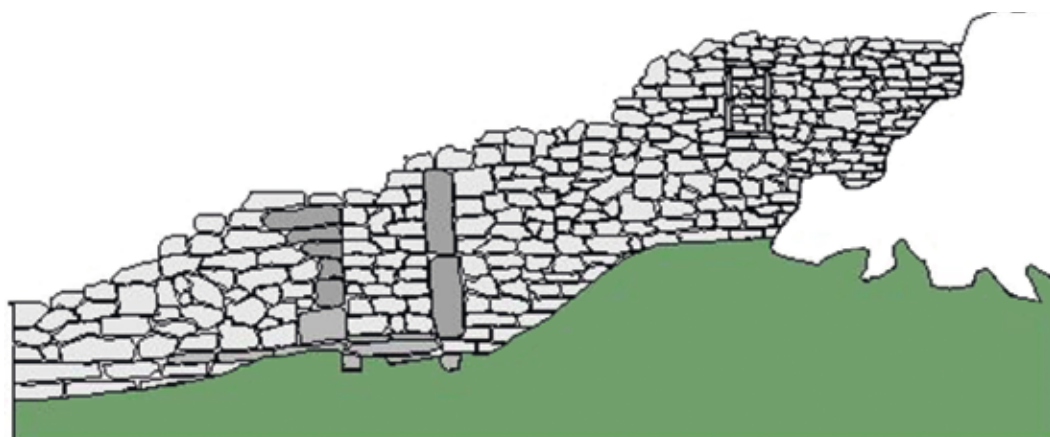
Detalle de la puerta y ventana cegadas en el muro occidental del cementerio.
